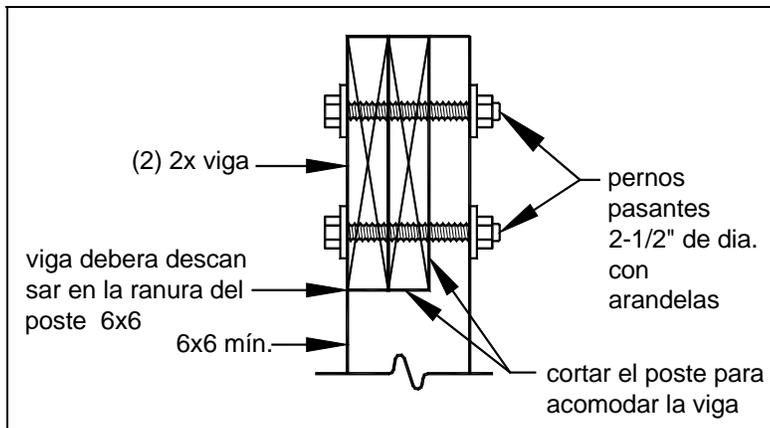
REQUISITOS DE UNIÓN DEL PILAR CON LA VIGA
